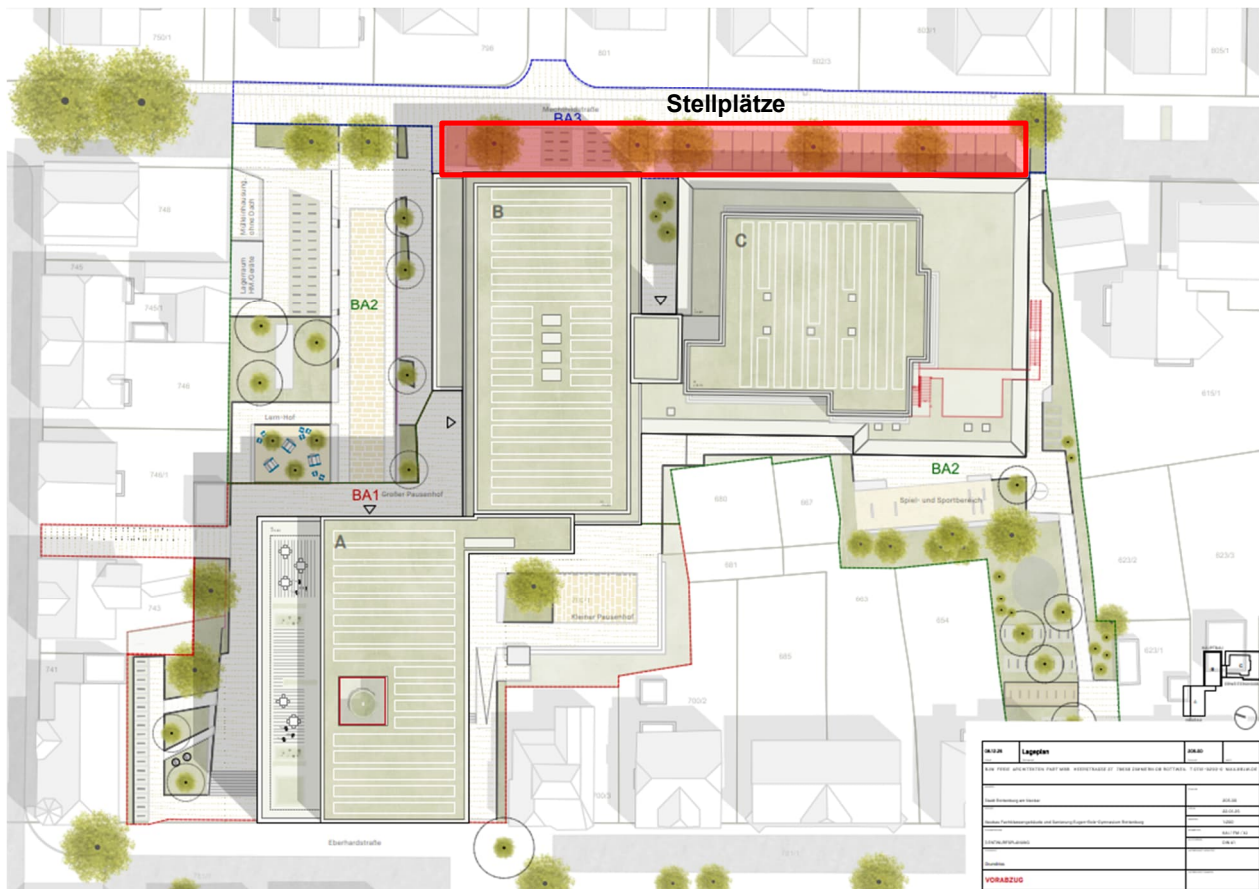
Lageplan mit Kennzeichnung der Stellplätze
